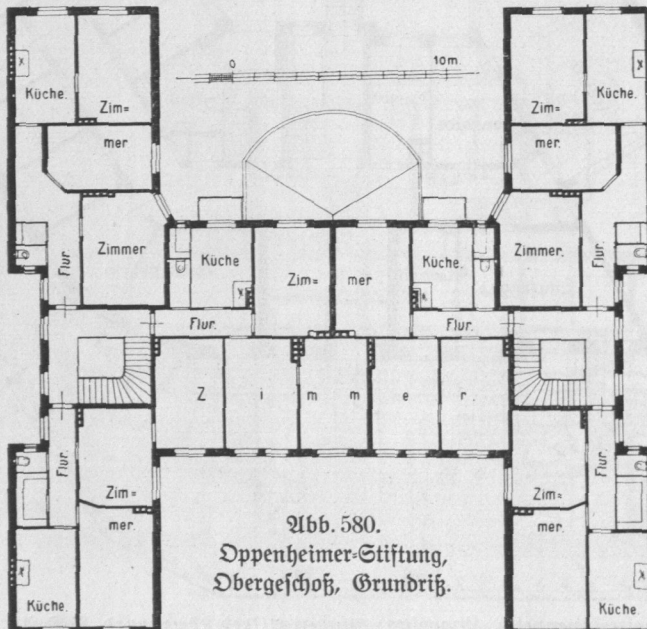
Dppenheimer-Stiftung, Obergeschoss, Grundriß.
